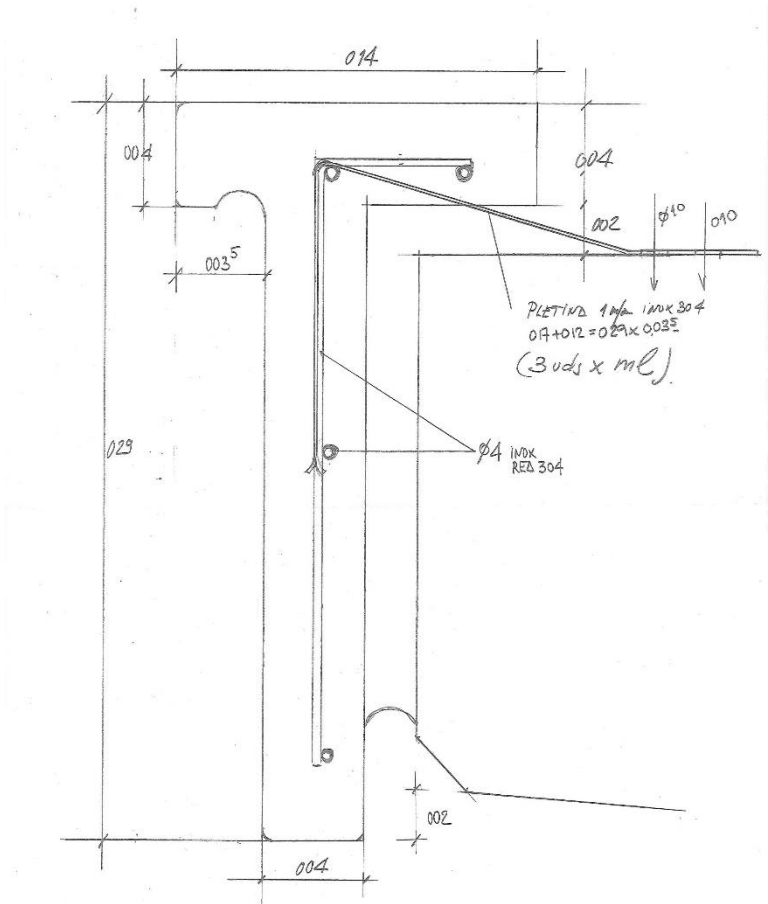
Pieza de coronación de canto de forjado y armadura interior
